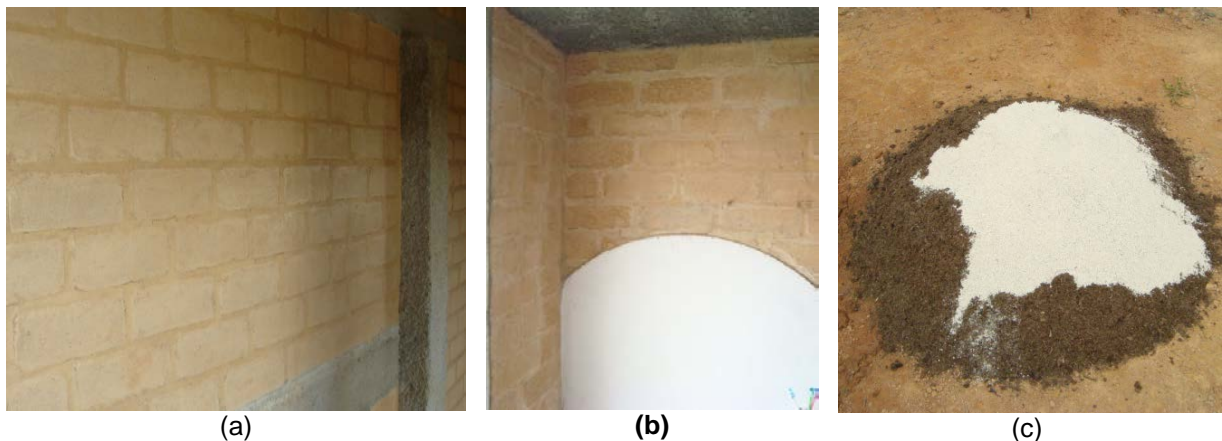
(a) Detalle de muro interno con acabado con BTC a la vista y (b) muro baño sin empañetar; (c) tierra blanca con fibra natural, cagajón
